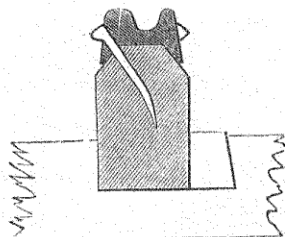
Tramway Loubat. Coupe du rail et de la longuerine. Échelle 1/8.
